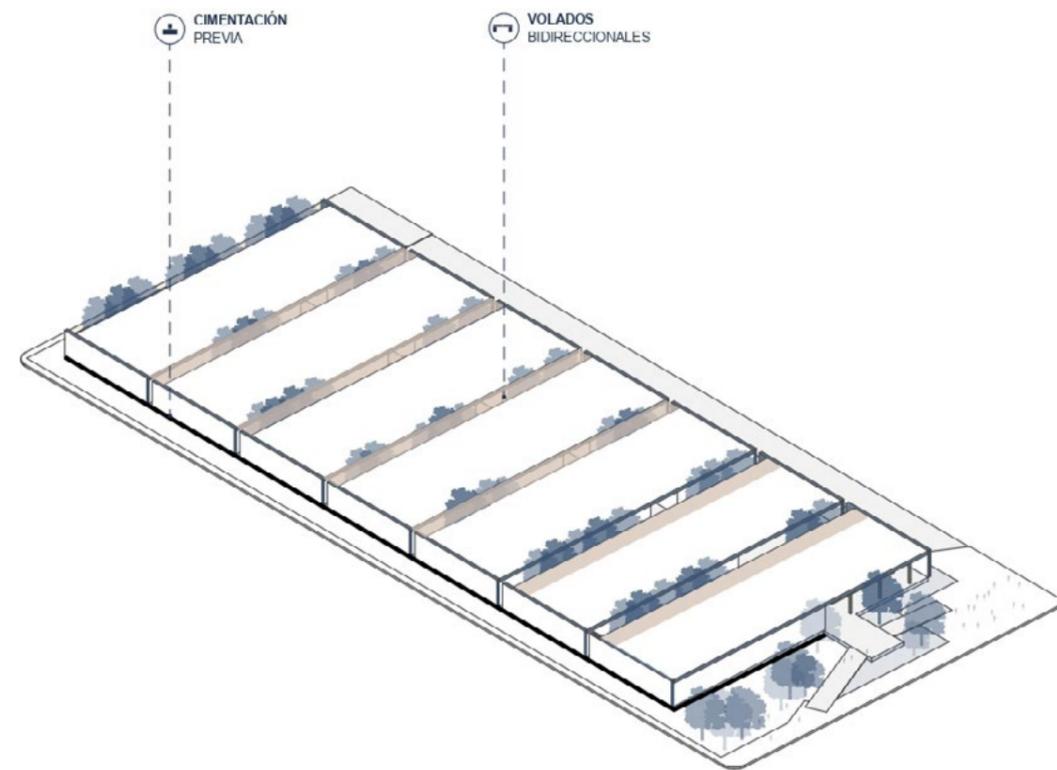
Sistema constructivo. Fuente: Elaboración propia, 2025.
